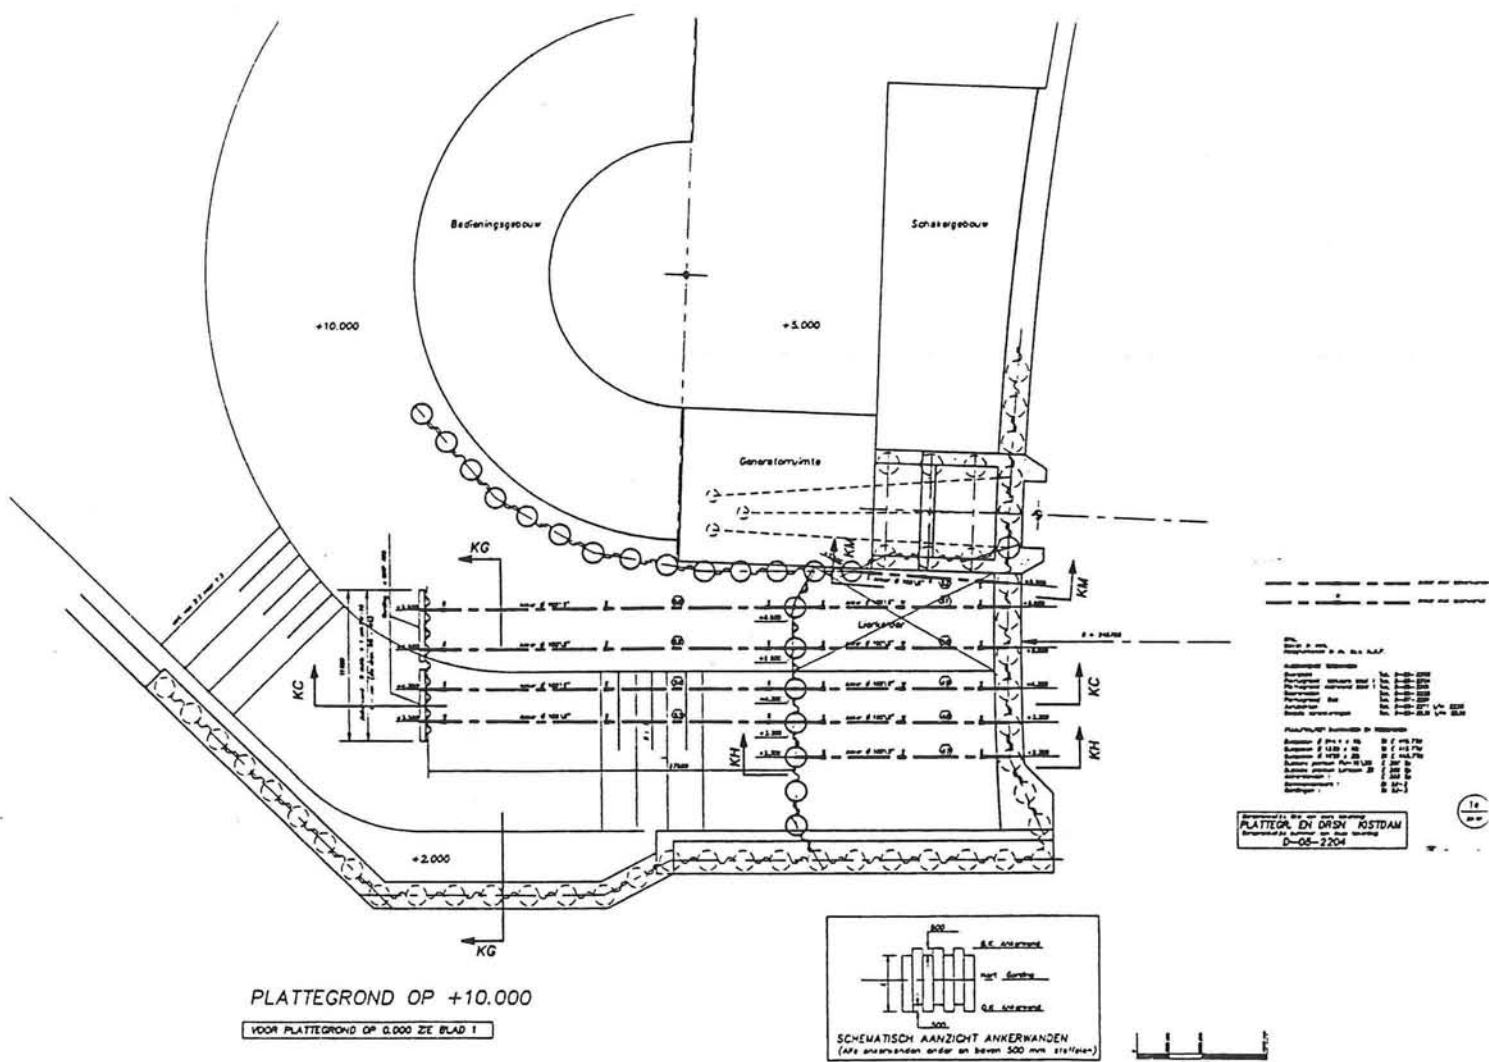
Overzicht grondkerende constructie van het landhoofd
